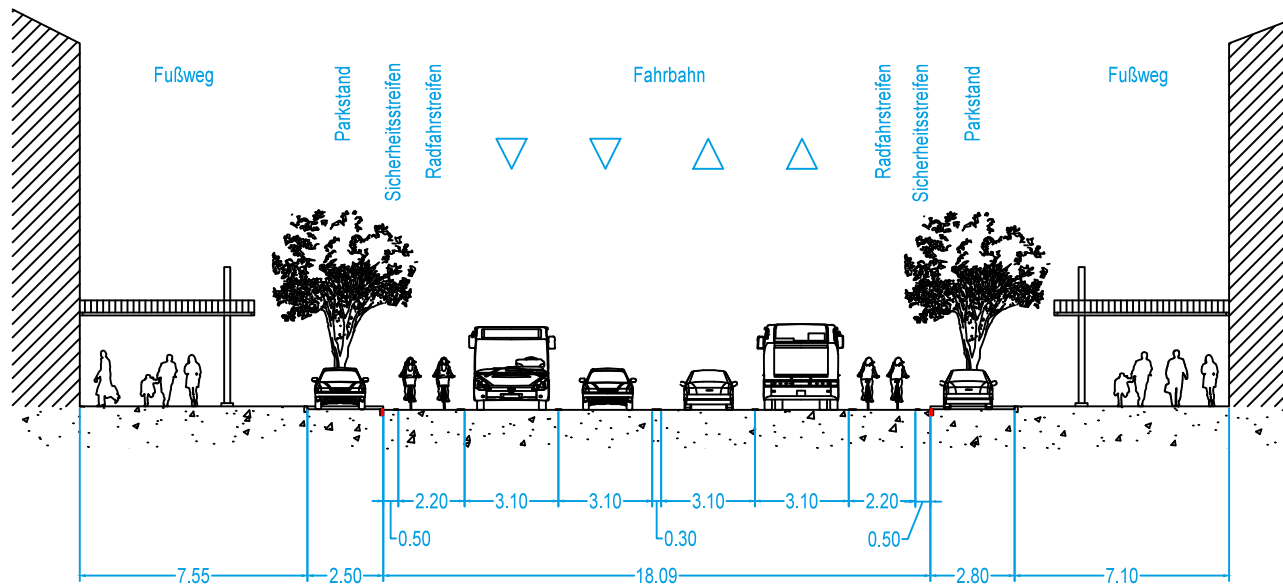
Variante 4: Lösung mit Radfahrstreifen unter Erhalt der vorhandenen Parkstände (1 : 250)
